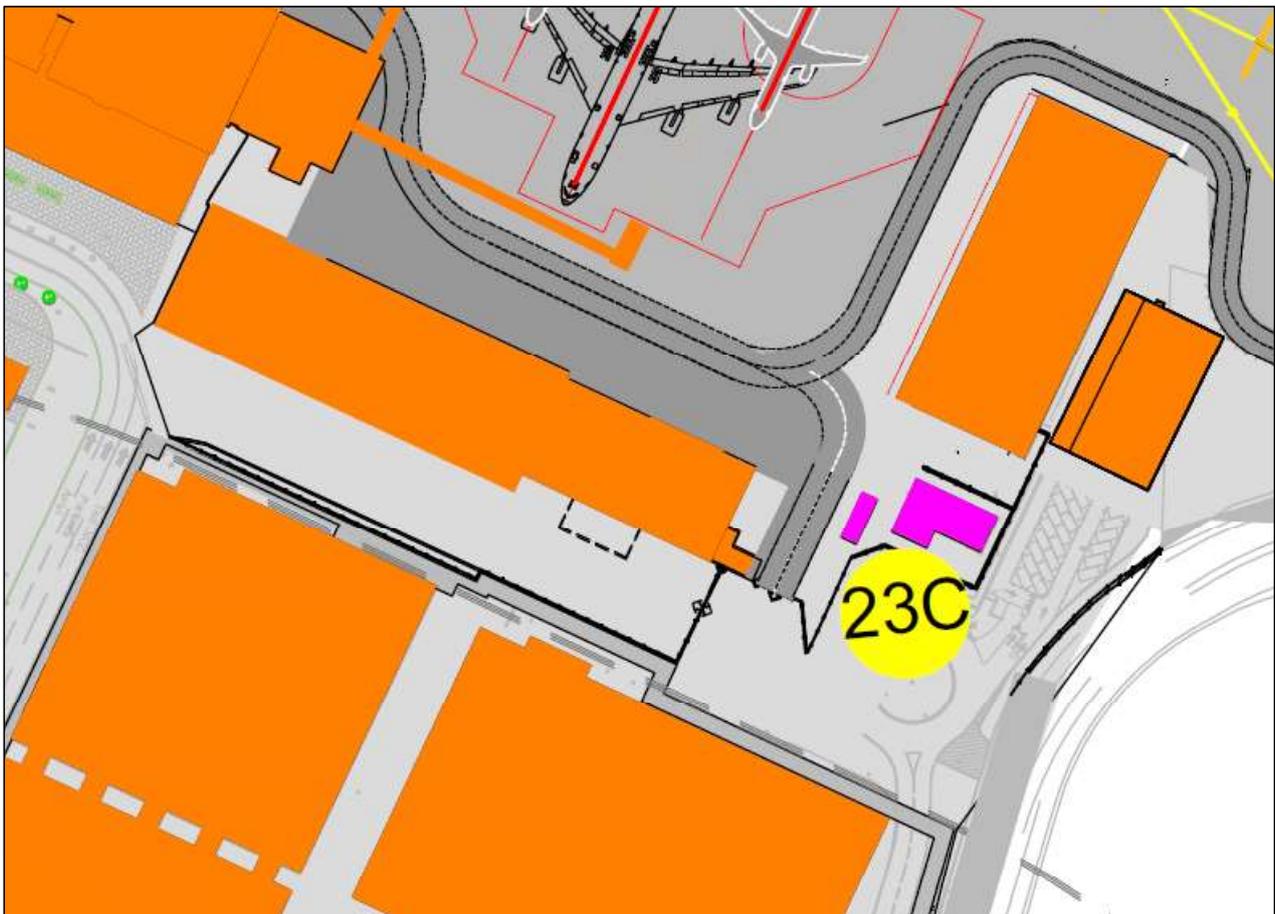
Estratto Master Plan – Nuovo Polo Tecnologico Est
